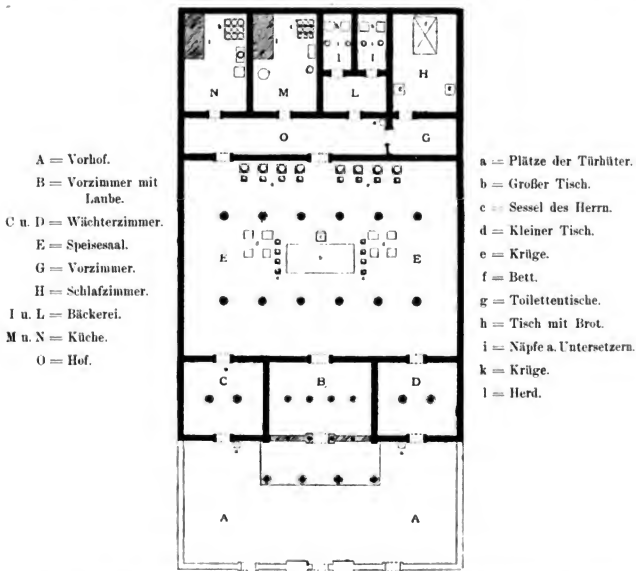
Haus des Merjre. Grundriss nach den beiden vorigen Bildern hergestellt. (S. 113.)
